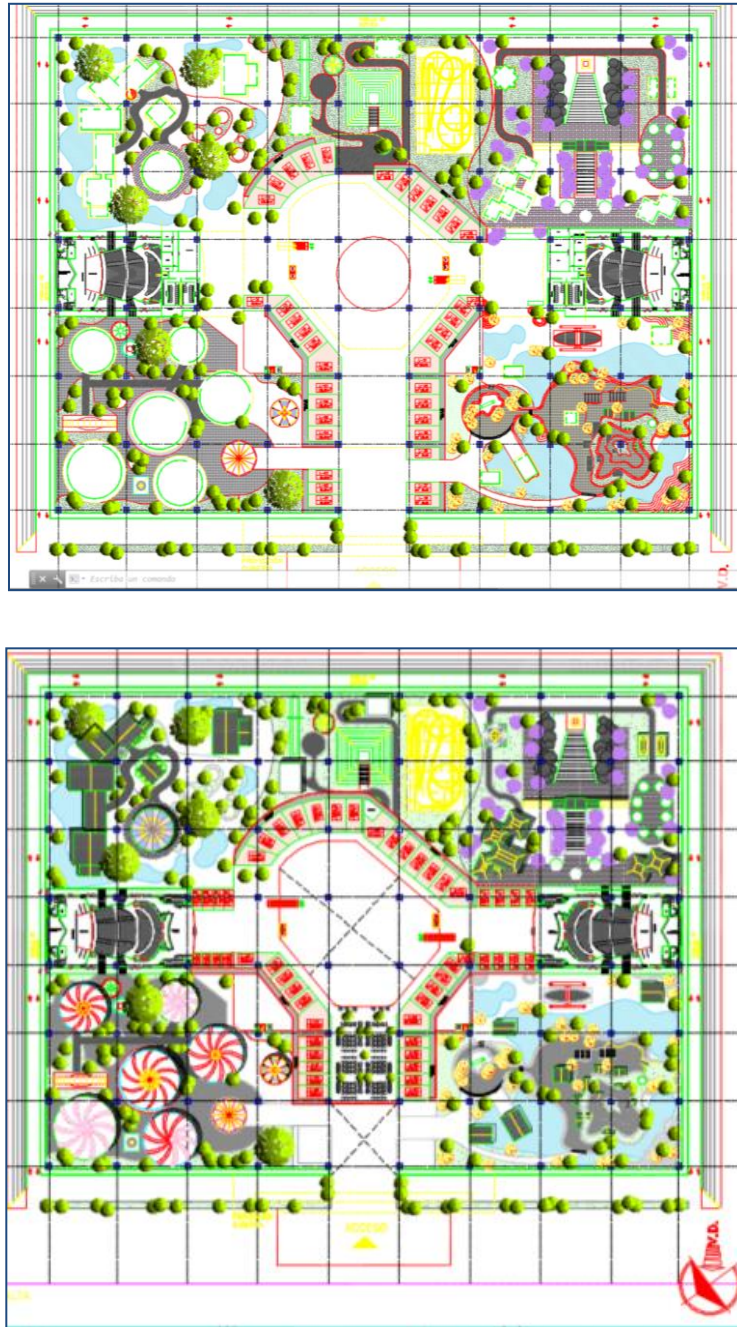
Planta Baja (Arriba) y Planta Alta (Abajo) del Parque Temático Dream Park.
